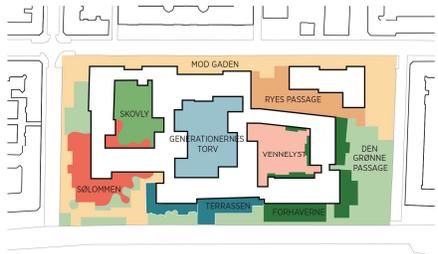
Planta de conjunto The Future Solund. Fuente: Tredje Natur.
